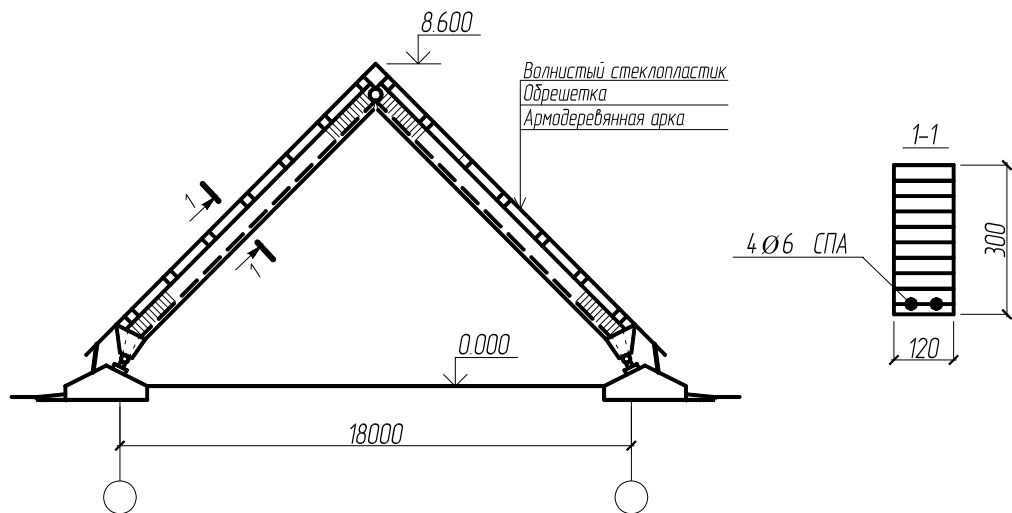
Клееные арки с предварительно напряженной стеклопластиковой арматурой в покрытии склада химудобрений (Беларусь)
